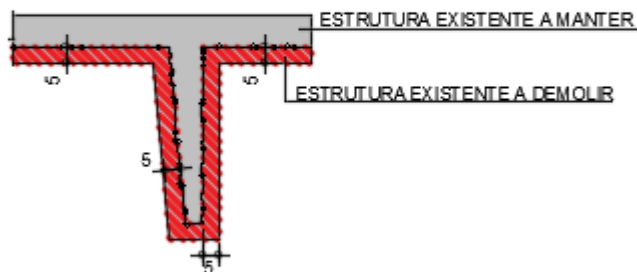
Recuperação das Lajes Pi – Píer – Alto grau de corrosão das armaduras
